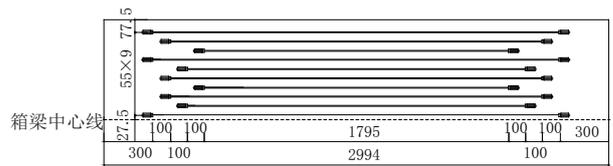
边跨箱梁 1/2 平面加固布置图(单位:cm)
